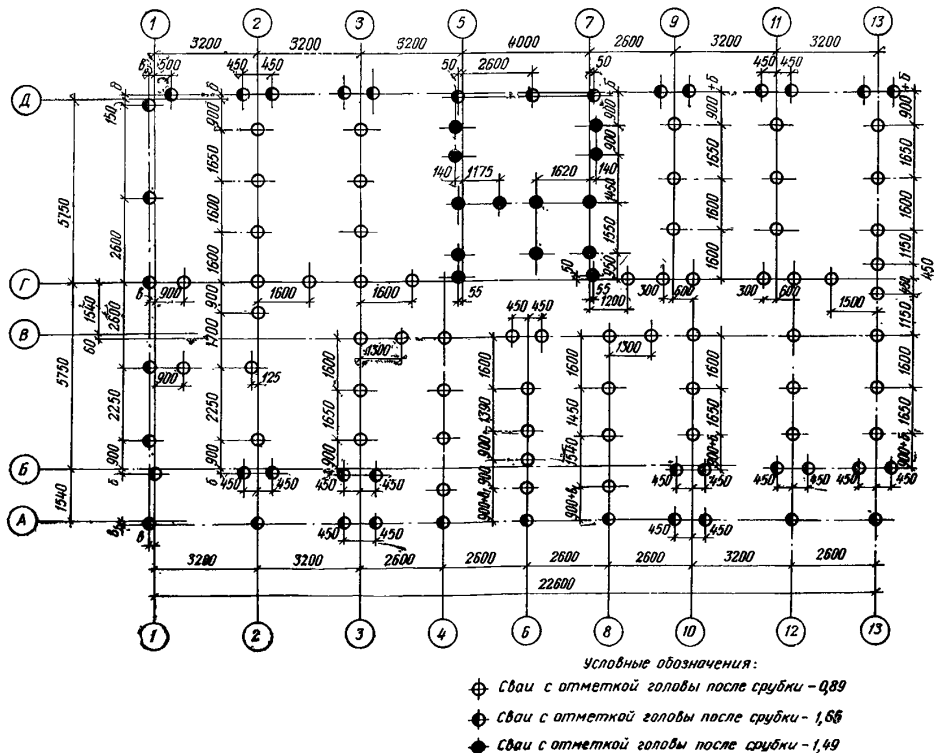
План расположения свай в фундаменте многоэтажного крупнопанельного жилого дома серии I-464Д-84-85. Нагрузка на сваю 40 т
